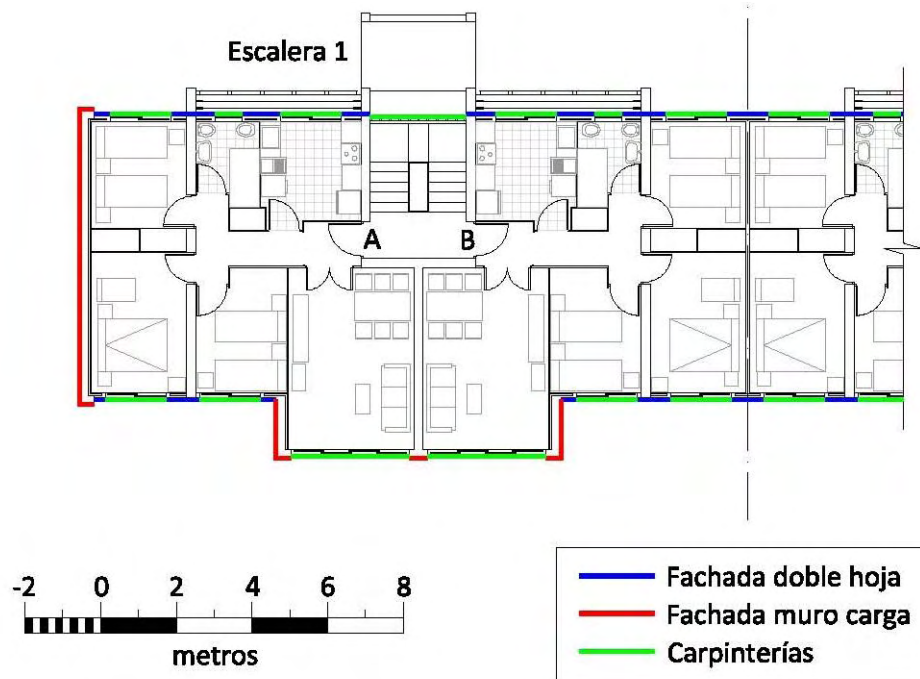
Elementos de la envolvente en planta. Escala 1:200
